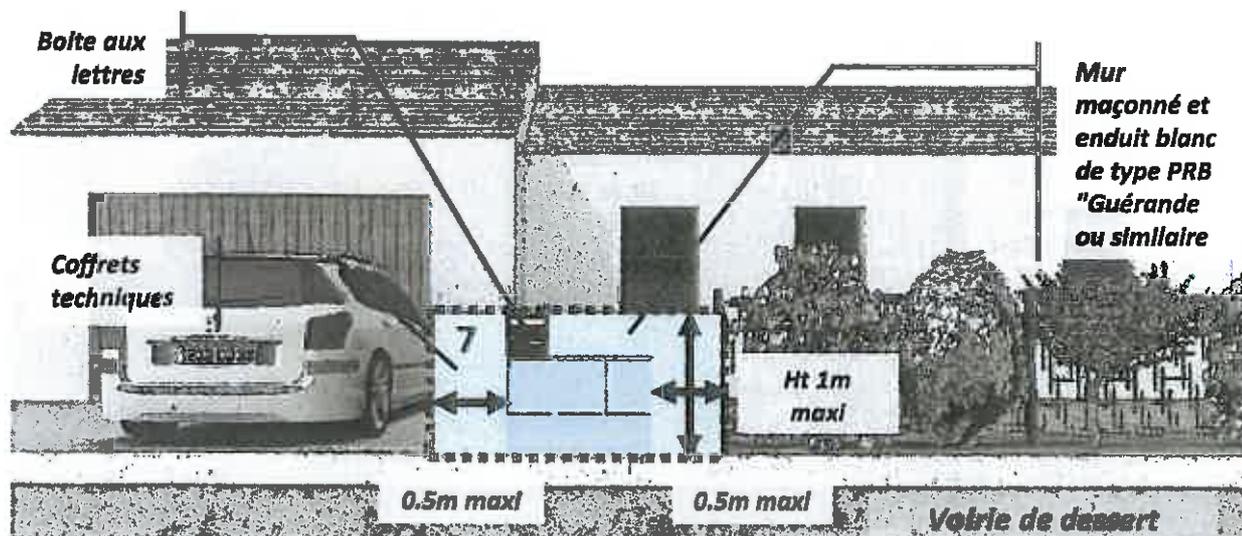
Maquette 3D du rendu concernant le muret maçonné autorisé pour habiller les coffrets et la boîte aux lettres
